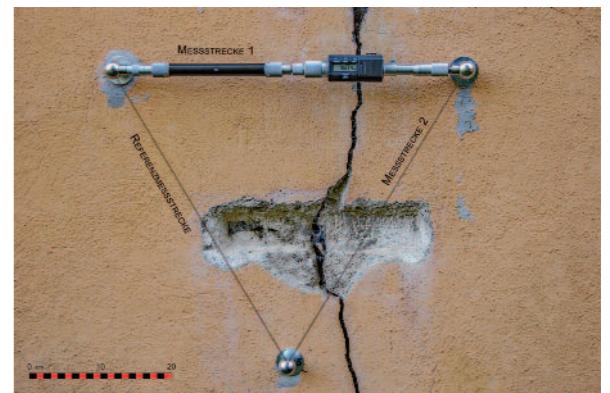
Pergolagartenmauer, vorhandener Riss mit Rissweitenmessstelle
